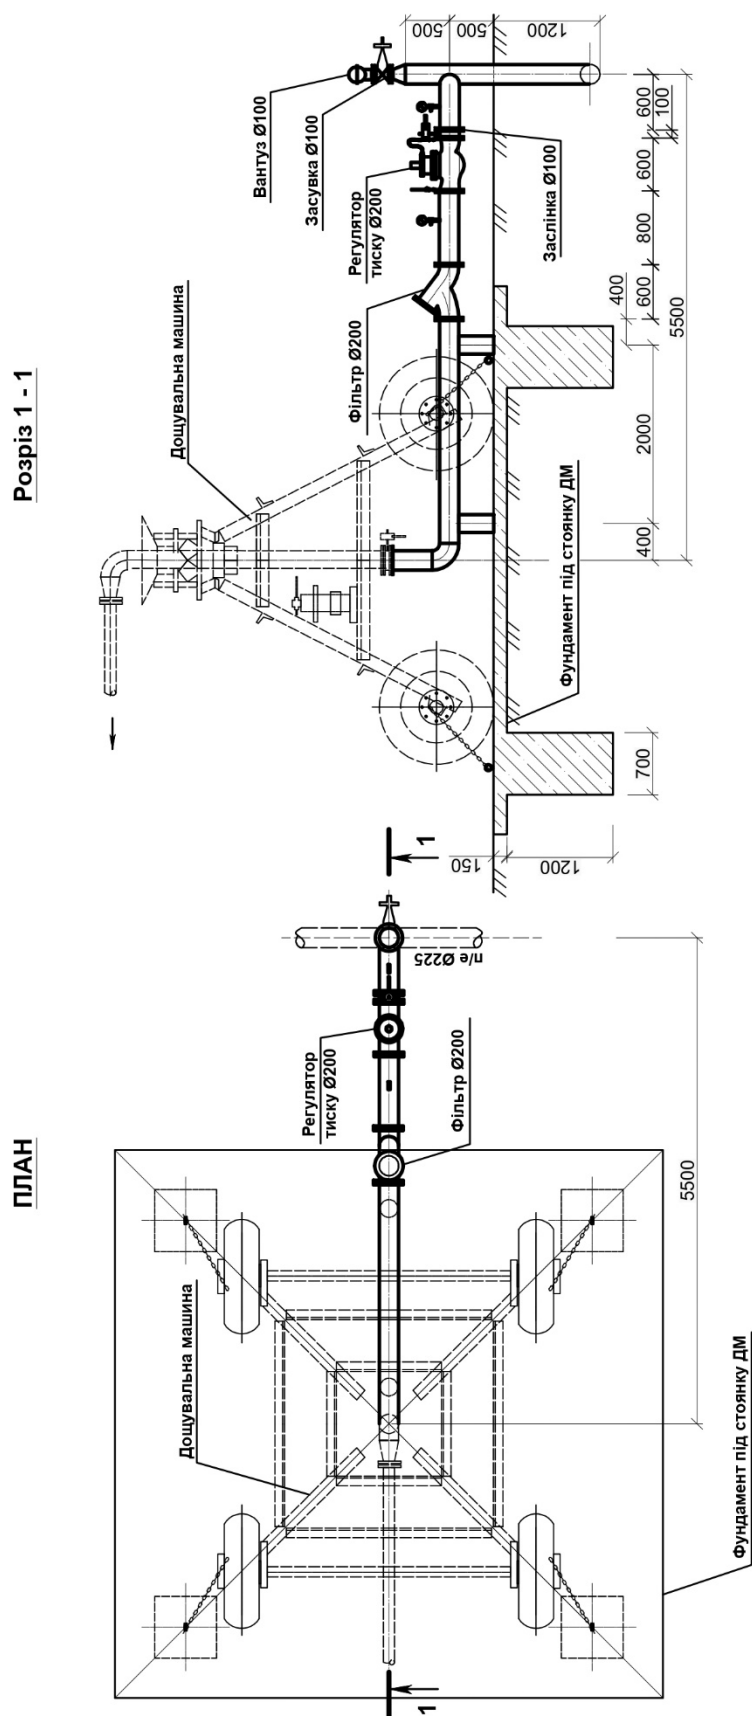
Монтажна схема опори для підключення ДМ Pivot
